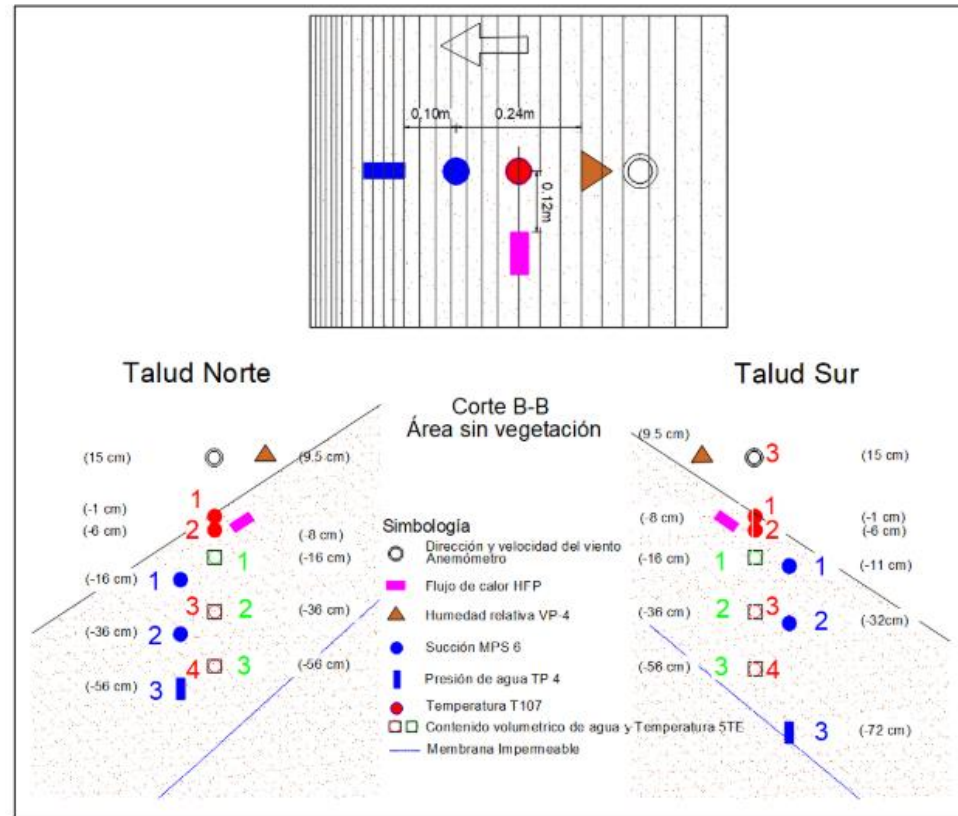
Detalle en planta y perfil, lado no vegetado del terraplén (Guachizaca Contenido, 2018)
